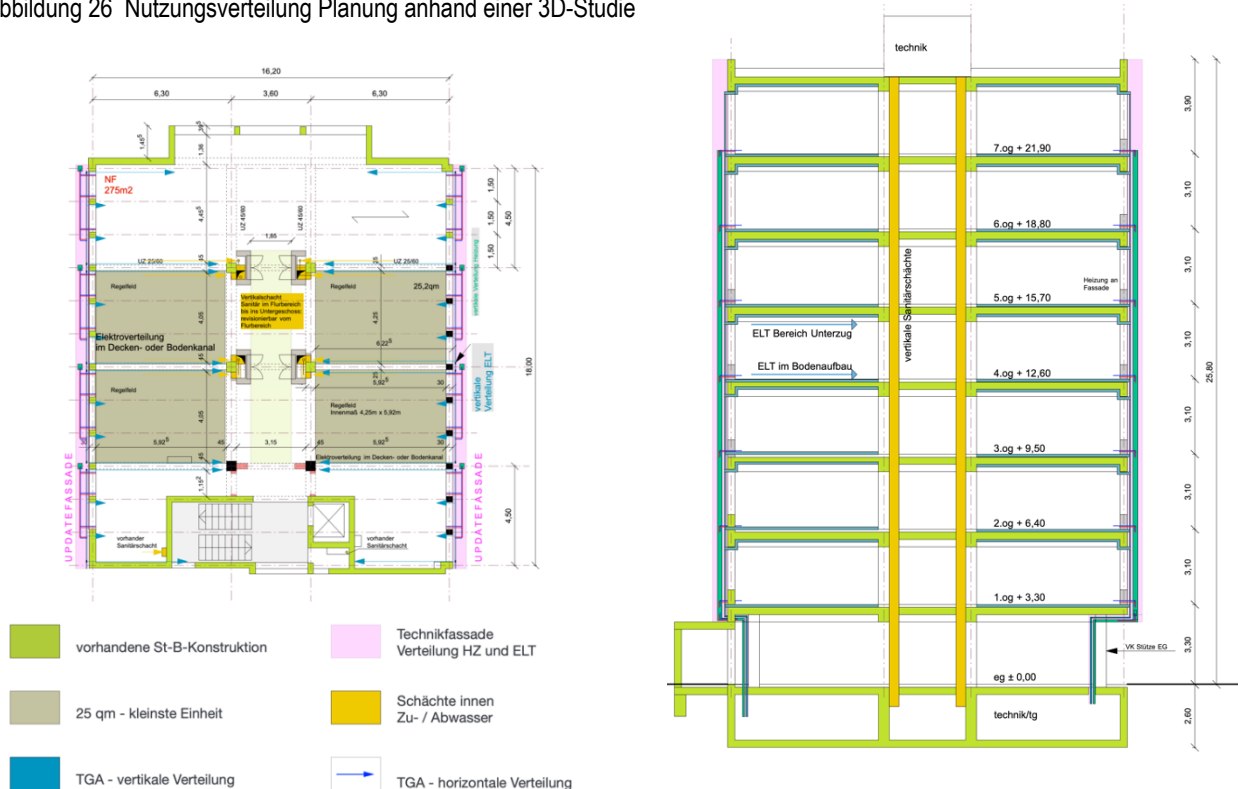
Darstellung einer möglichen Verteilung der neuen Infrastruktur in Grundriss und Schnitt
